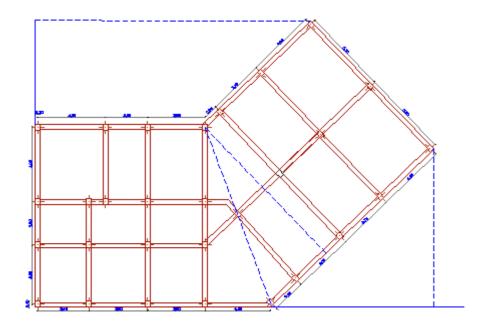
schéma détaillé pour calcul de centre de gravité.
